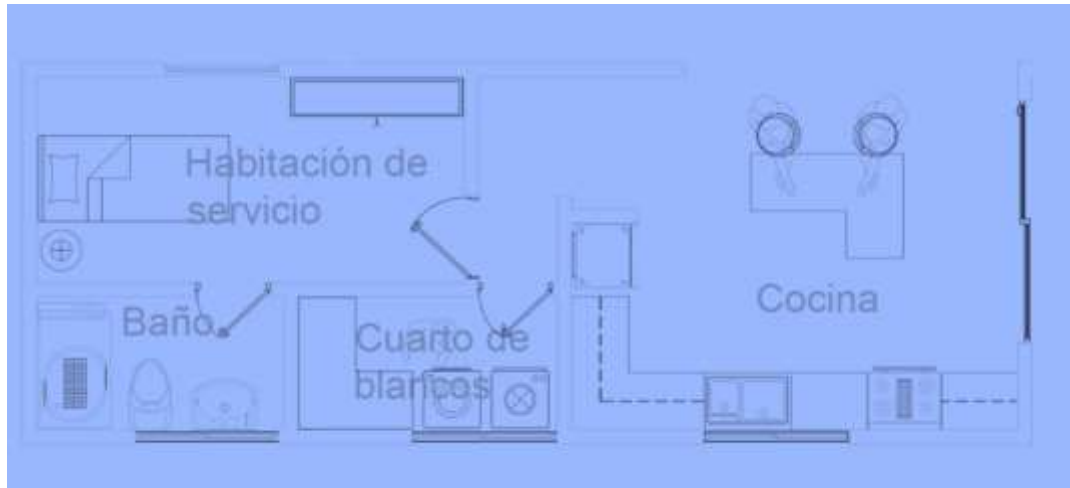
Módulo 3 Planta baja - Vivienda Bioclimática Modular sector Nobol
